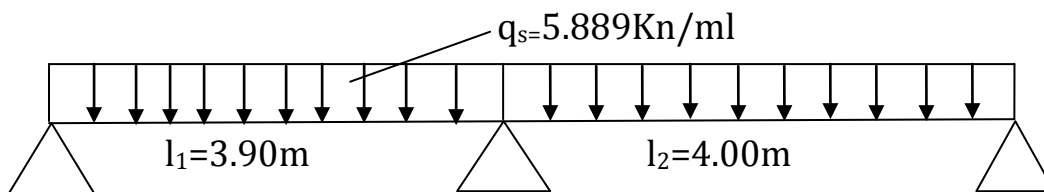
Schéma statique de la poutre continue reposant sur trois appuis.
